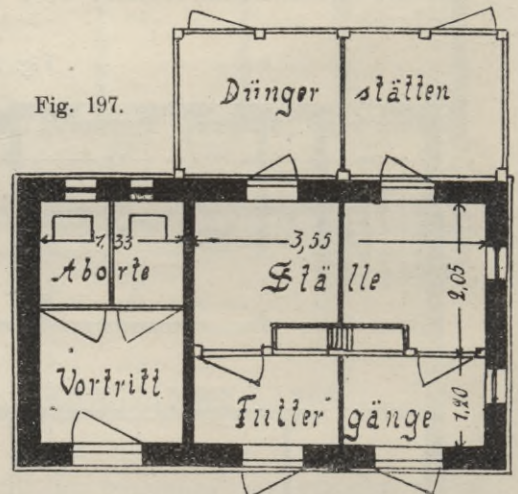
Grundriss des Stalles. Jede Wohnung hat einen Abort, einen Futtergang, einen Stall und eine Düngerstätte für sich.
